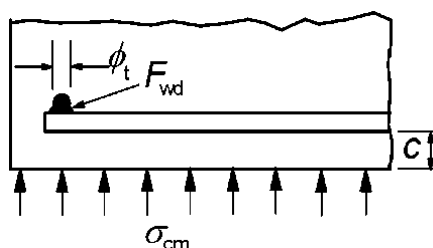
Приваренный поперечный стержень как анкерное устройство
